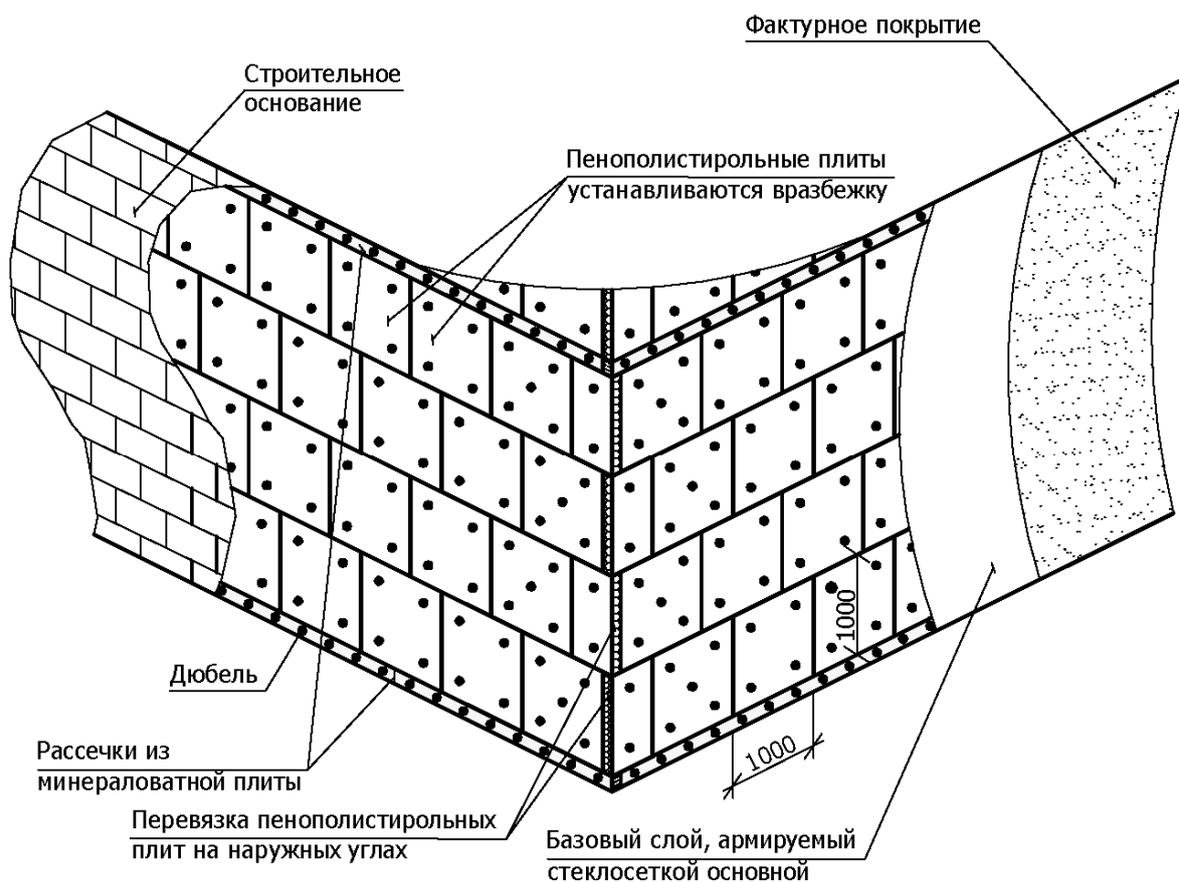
Система наружной теплоизоляции фасадов с применением в качестве утеплителя пенополистирольных плит ЛАЗЭС-П
